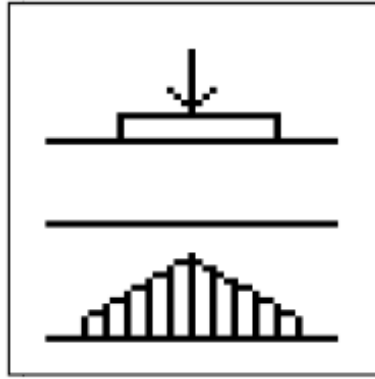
Distribución de esfuerzos de un pavimento flexible.
